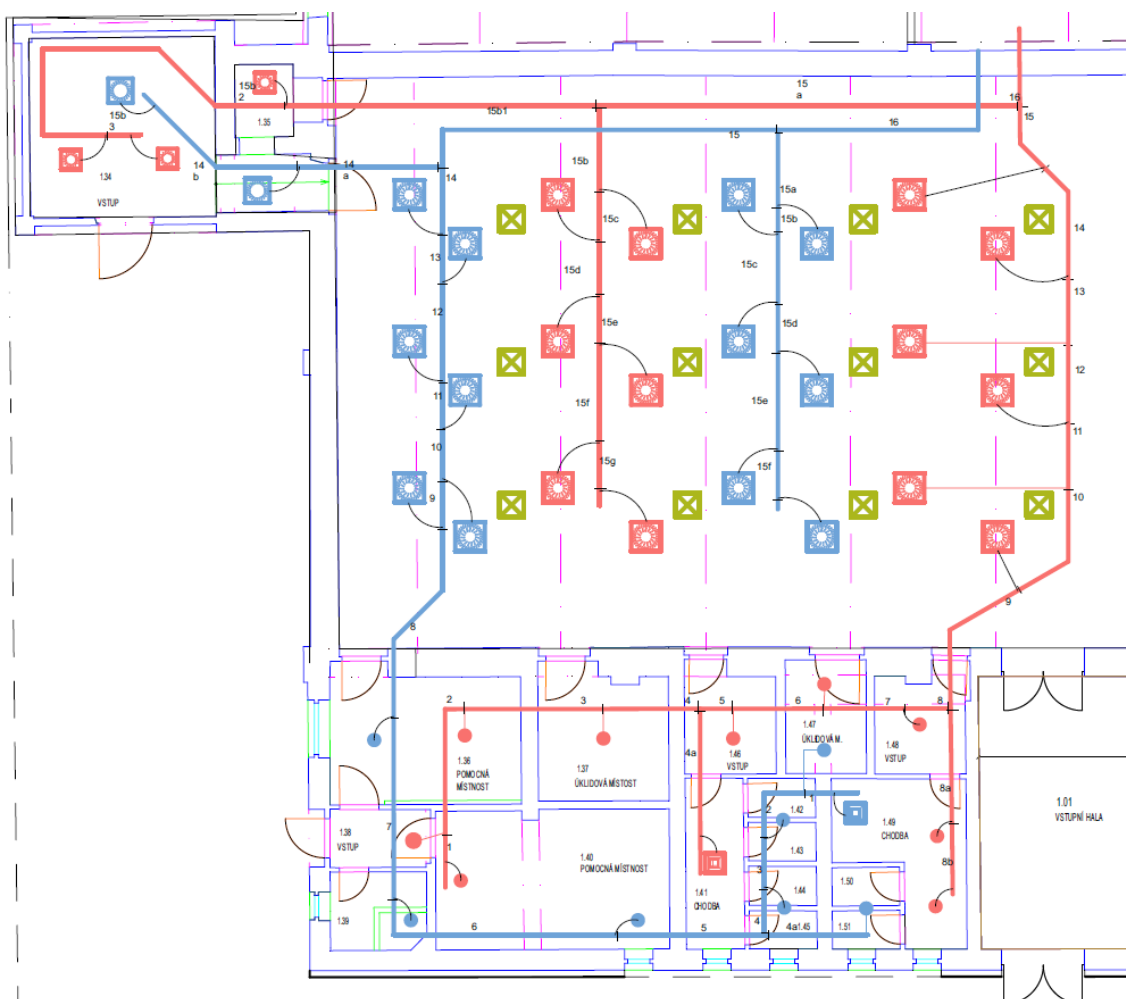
Dimenzační schema zařízení č. 2 - Zázemí (1/3)
